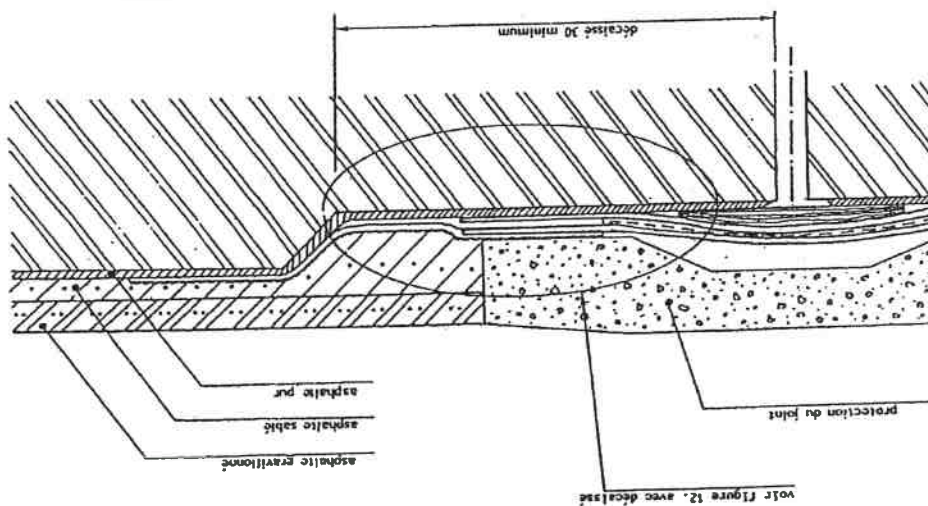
Raccordement à un revêtement asphalté Toitures accessibles aux piétons, au séjour et aux véhicules avec protection rapportée en maçonnerie (par ex.: type 5 + 15 + consolidation + béton)
